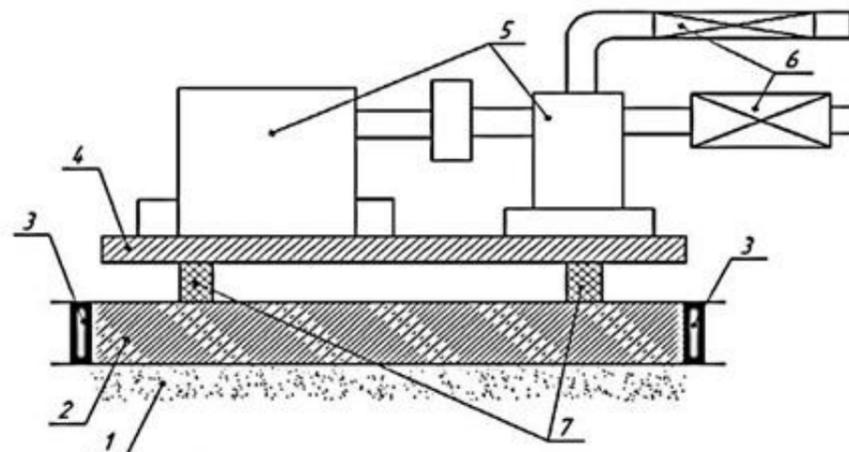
Схема звукоизоляции водопроводного насоса:
